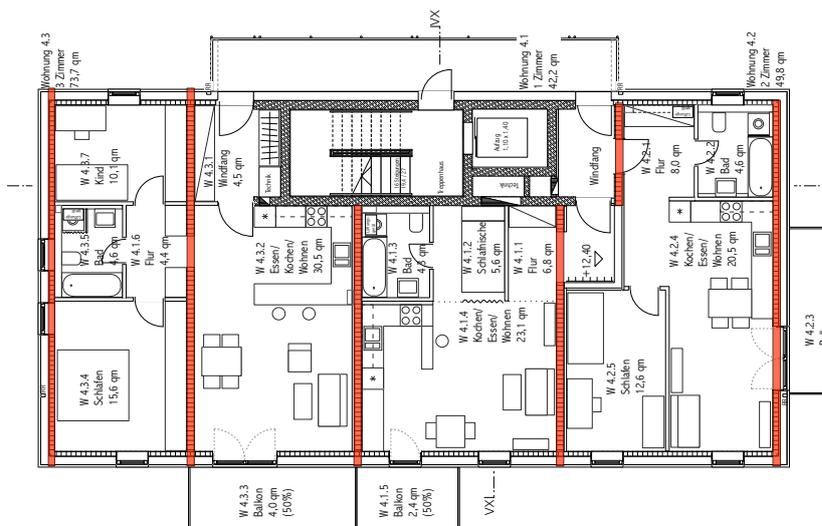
Typengrundriss mit tragenden Wänden (rot)
